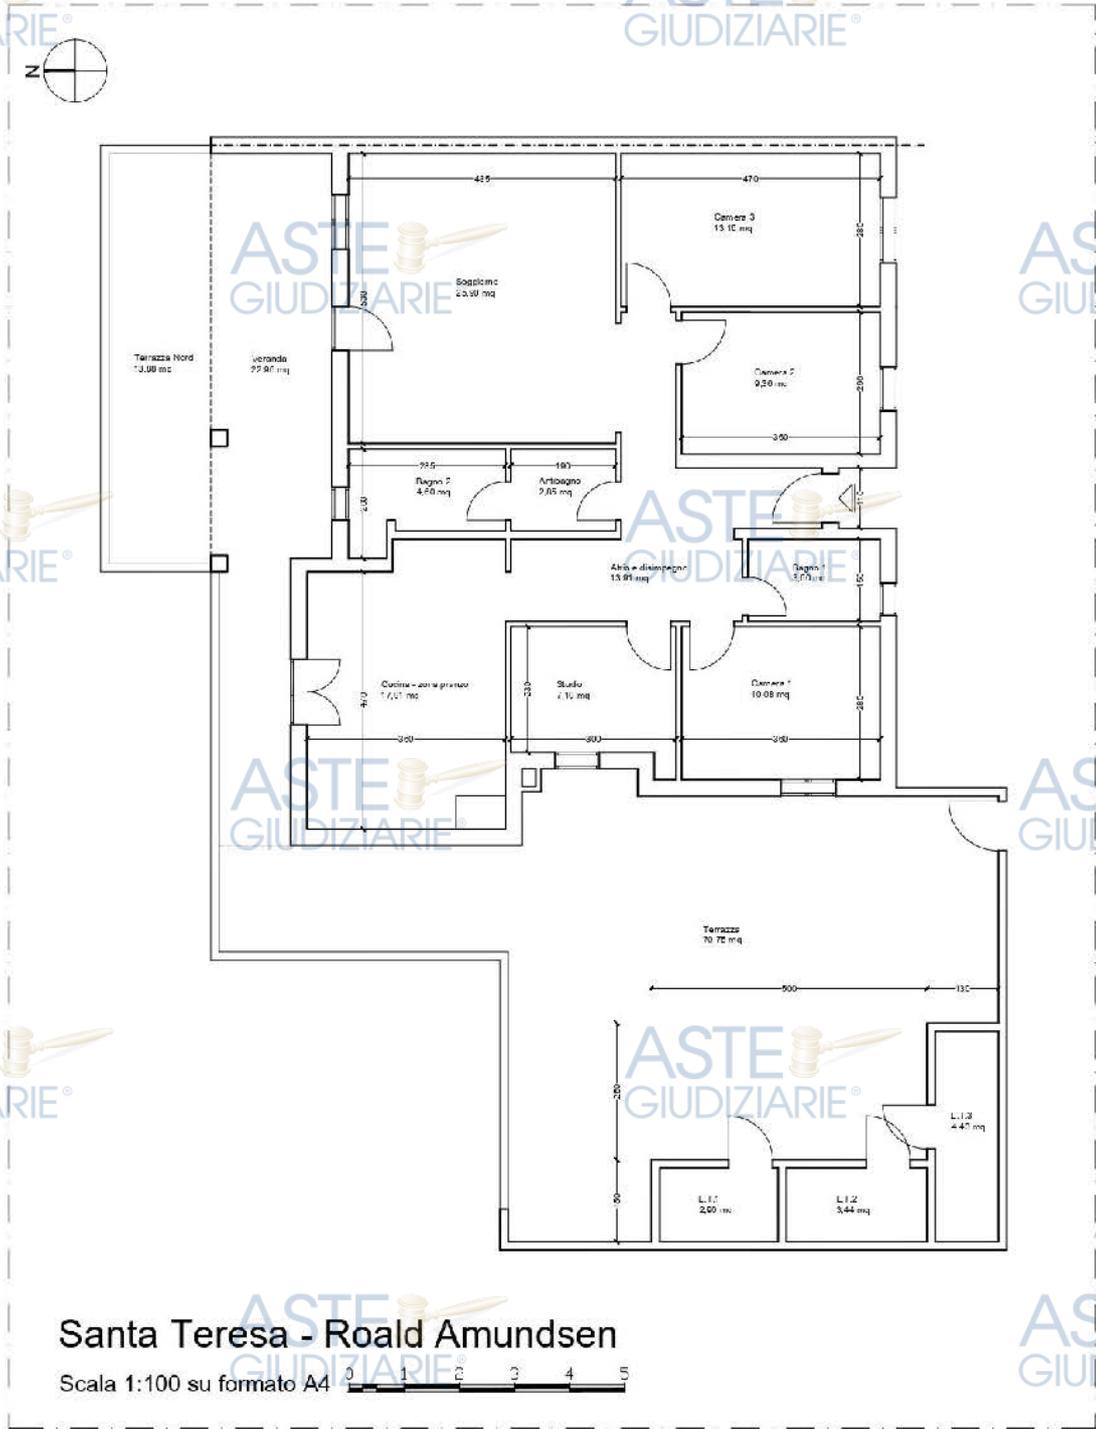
Planimetria dello stato di fatto – pianta piano terra
